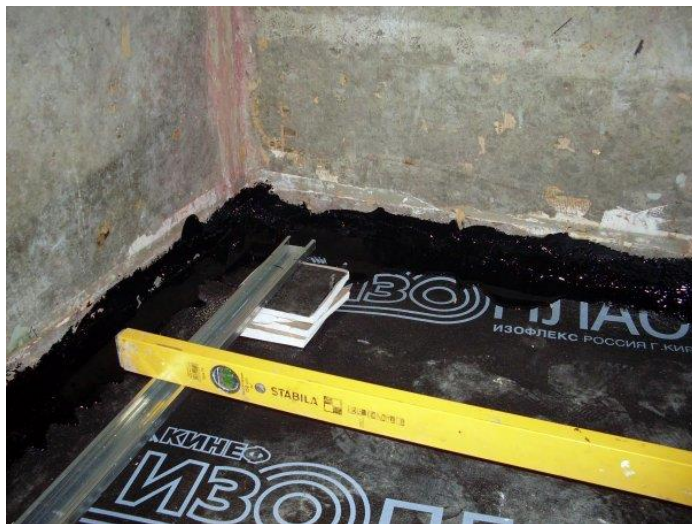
Монтаж рулонного кровельного гидроизоляционного материала в подвале здания
